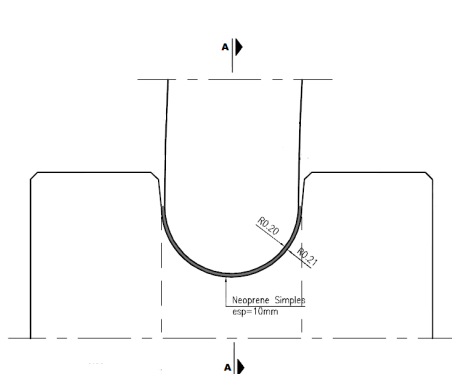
Pormenor da ligação entre a aduela e a fundação (COBA *et al.*, 2008)
